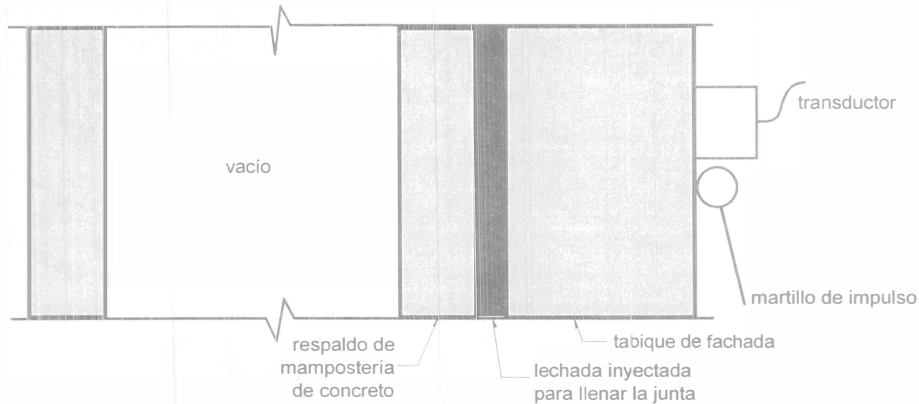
Sección transversal de un muro de mampostería de bloque de concreto estudiado mediante la técnica de medición del eco producido por un impacto. En este ejemplo, las pruebas pretenden determinar si la junta entre el bloque de concreto y la fachada fue efectivamente rellenada durante la inyección de lechada.
